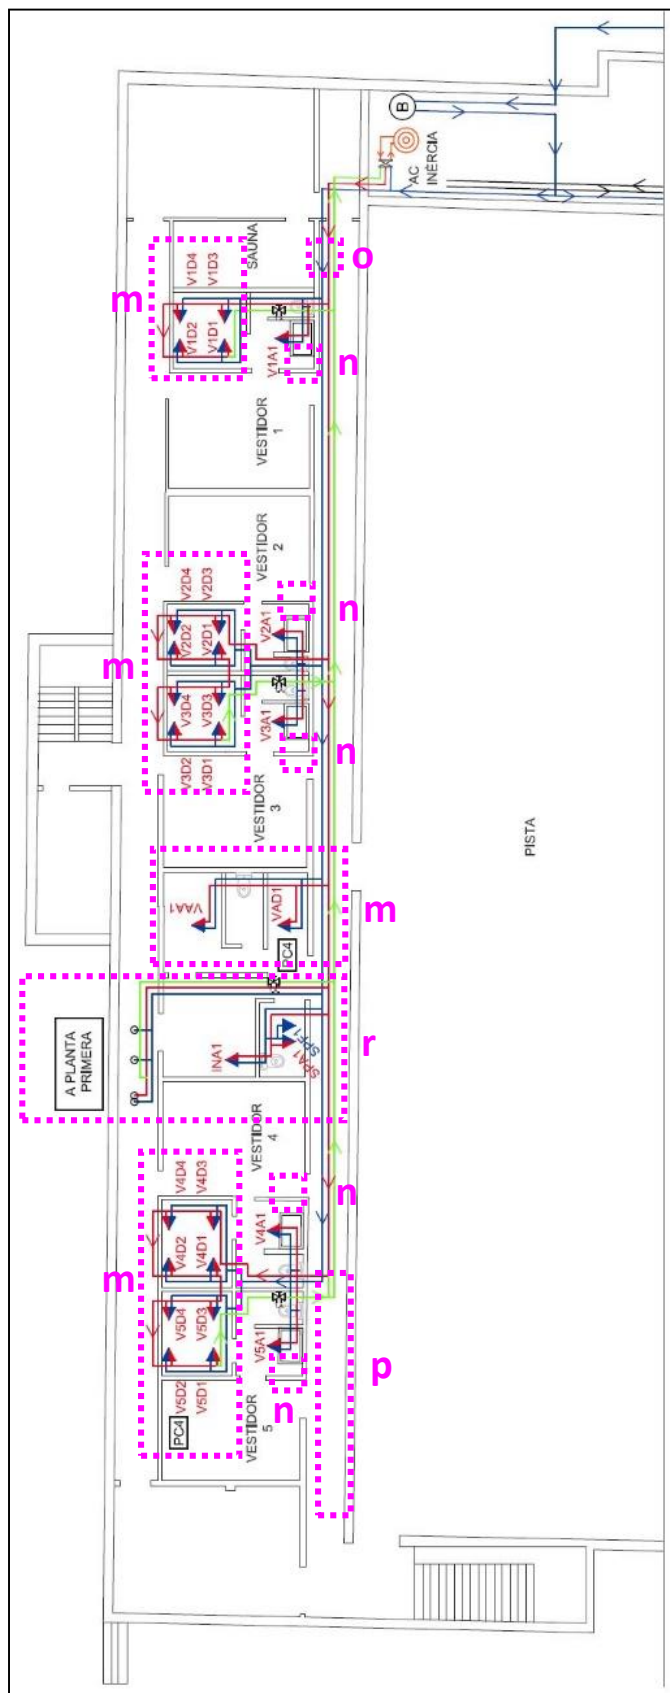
Detall traçat de canonades i dutxes dels vestidors planta baixa.
